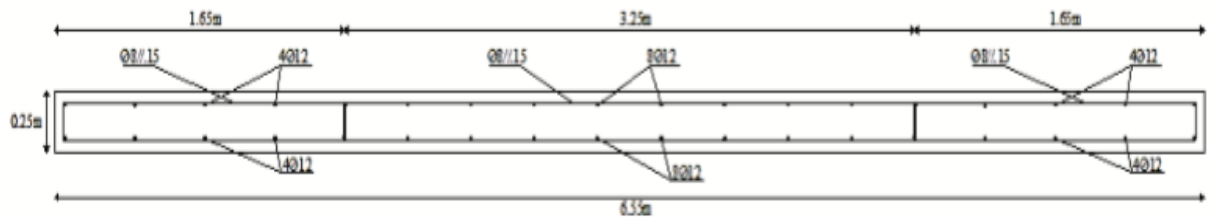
Secção transversal da parede resistente adicionada na direção transversal (Furtado, 2013).
